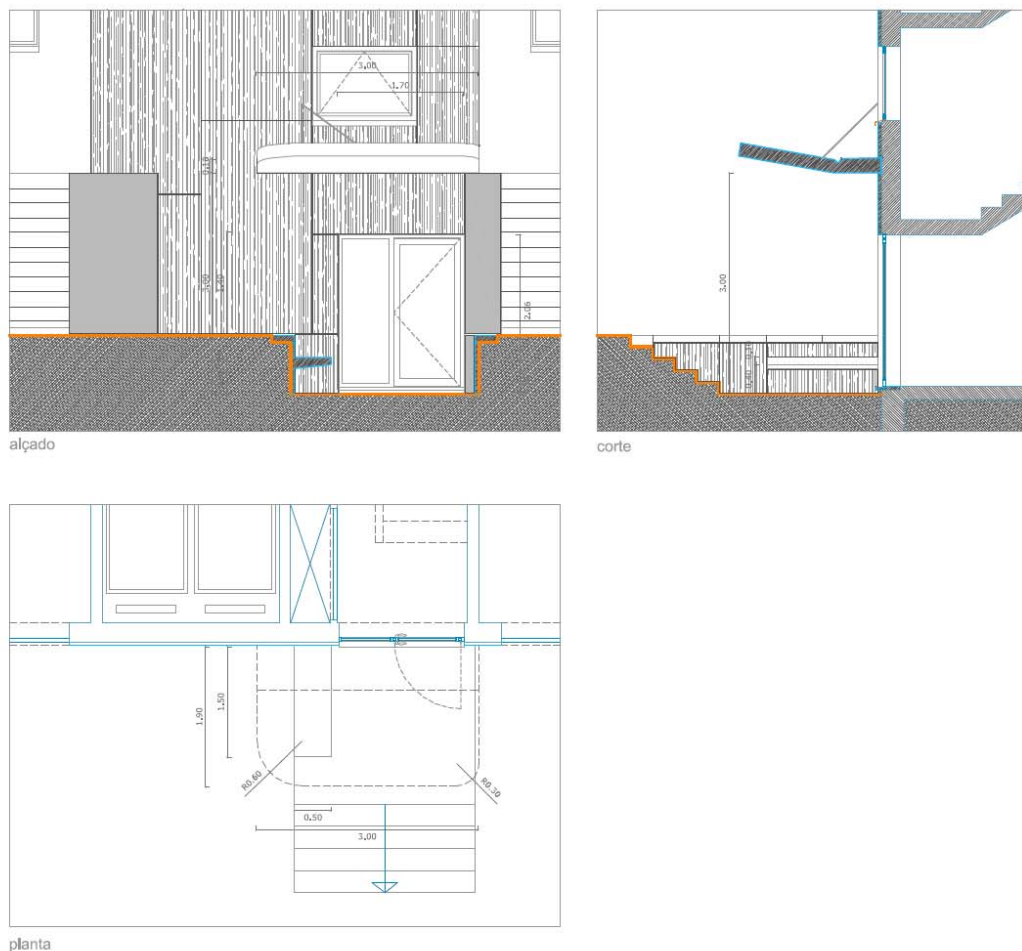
Proposta de requalificação de entrada de tipologia “plana”. Alçado, corte e planta. (escala 1/50).
